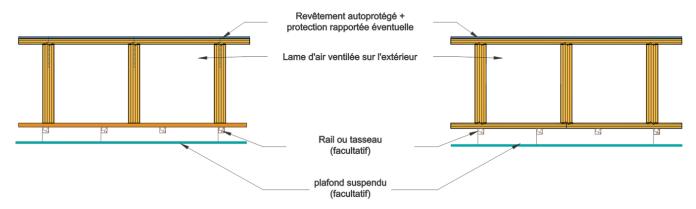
Rive de toiture froide ventilée non isolée (Auvent, préau, bâtiment ouvert non isolés et non chauffés)
